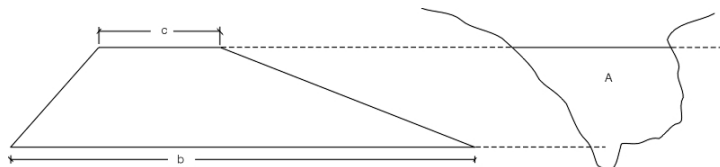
Perfil de la presa y área de la sección transversal del local de su construcción.
